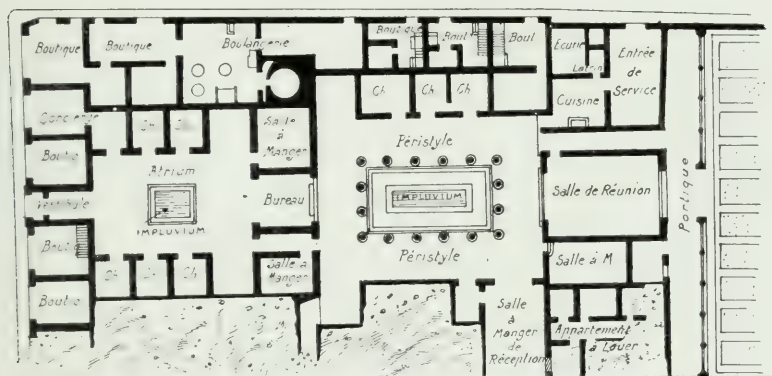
Coupe et plan de la Maison de Pansa, à Pompéi.
